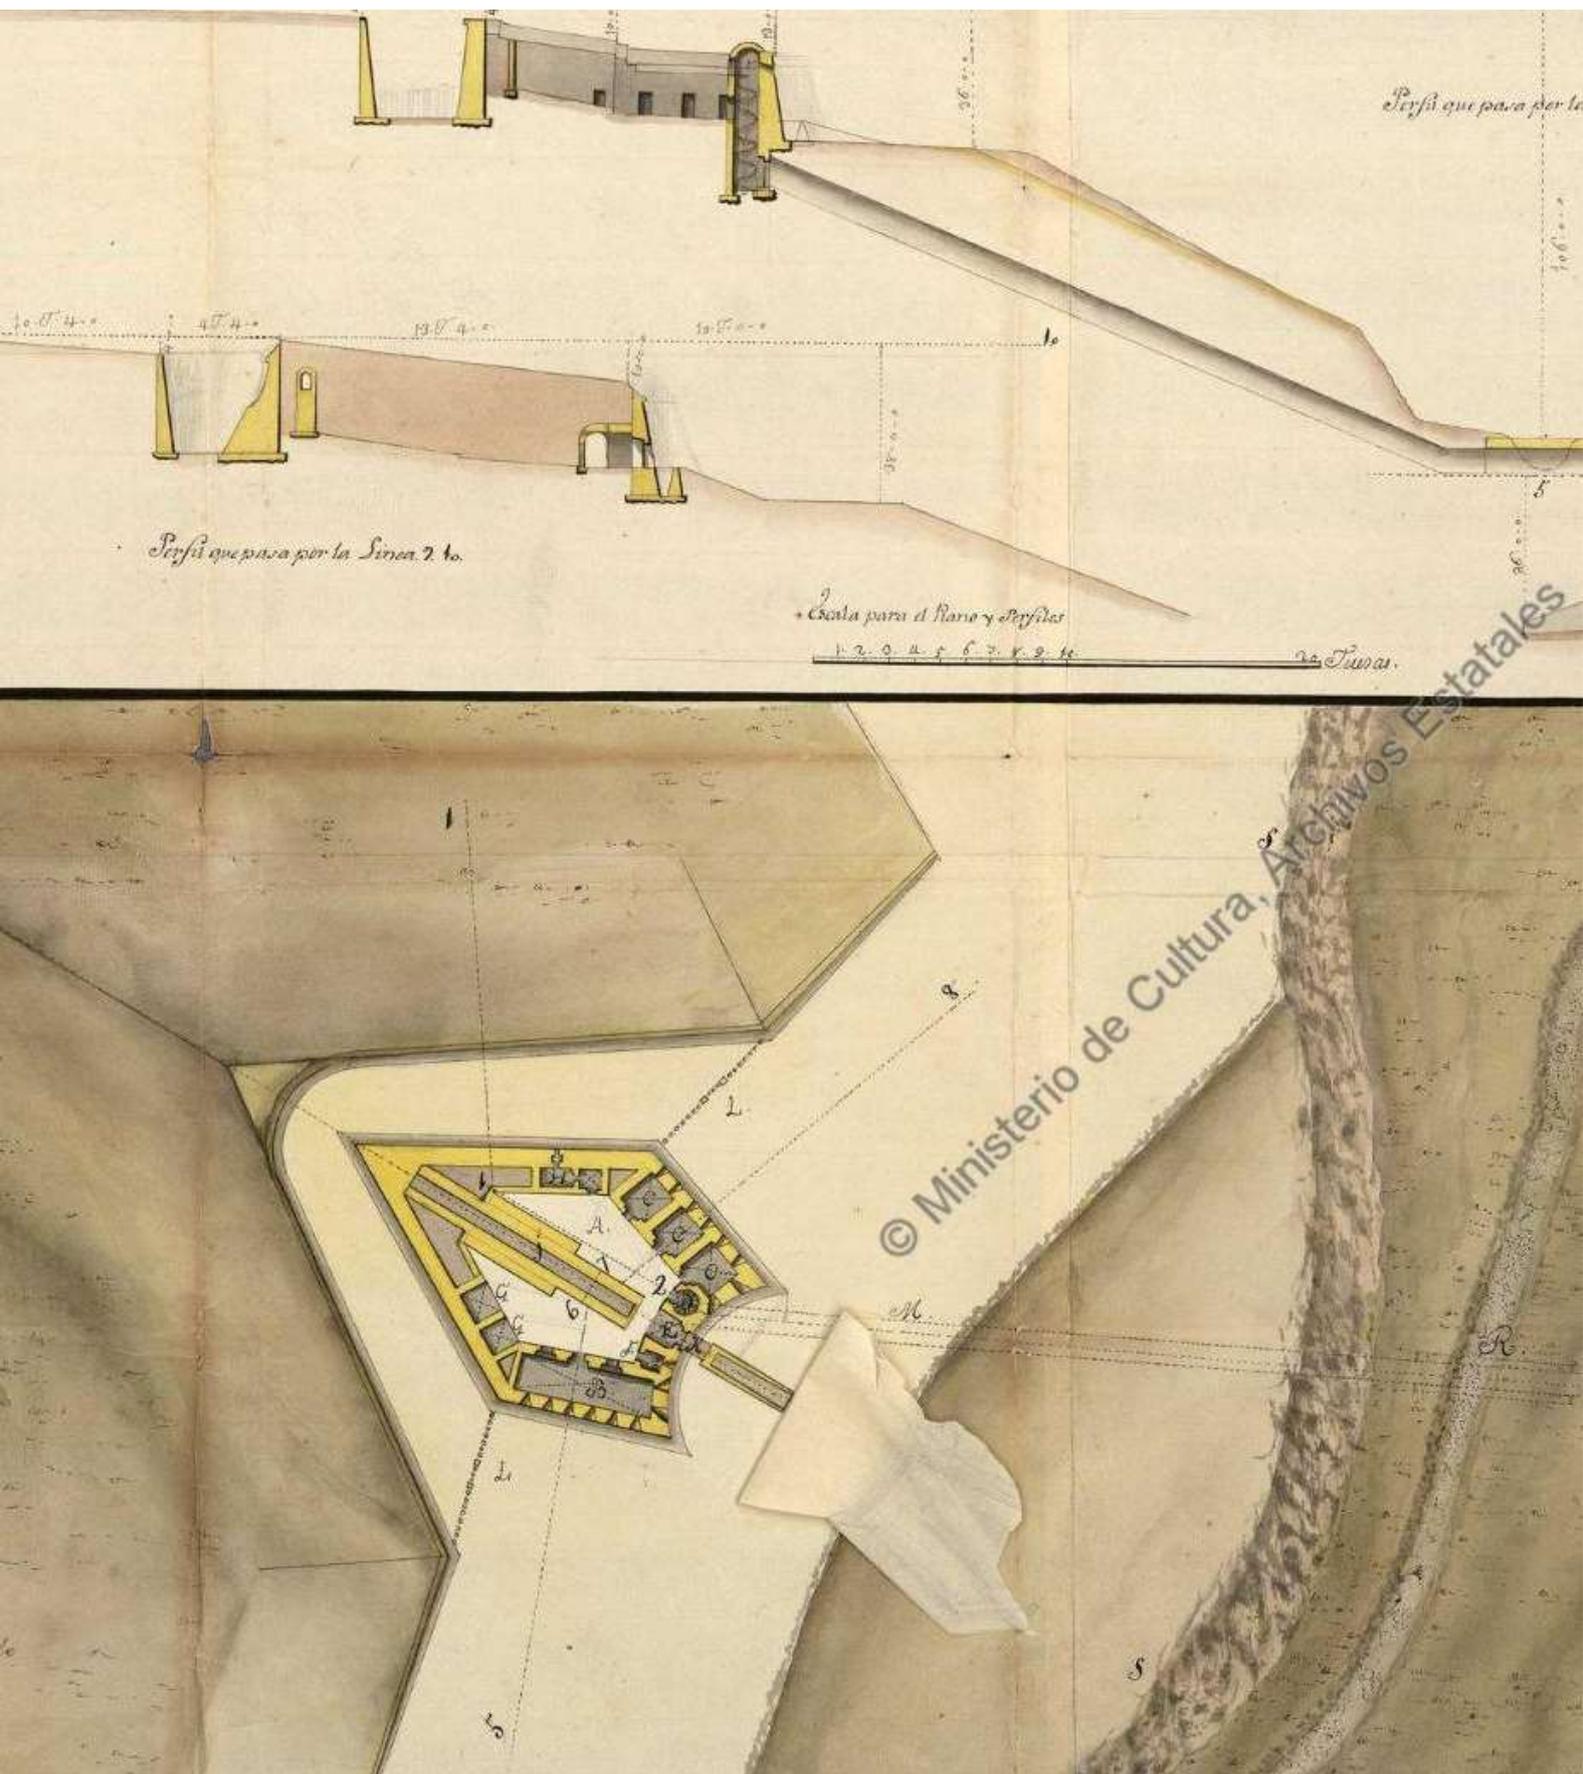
Planta de San Pedro por Juan Ballester en 1736 (AGS, SGU, Leg.03709. MPD, 11, 097).
